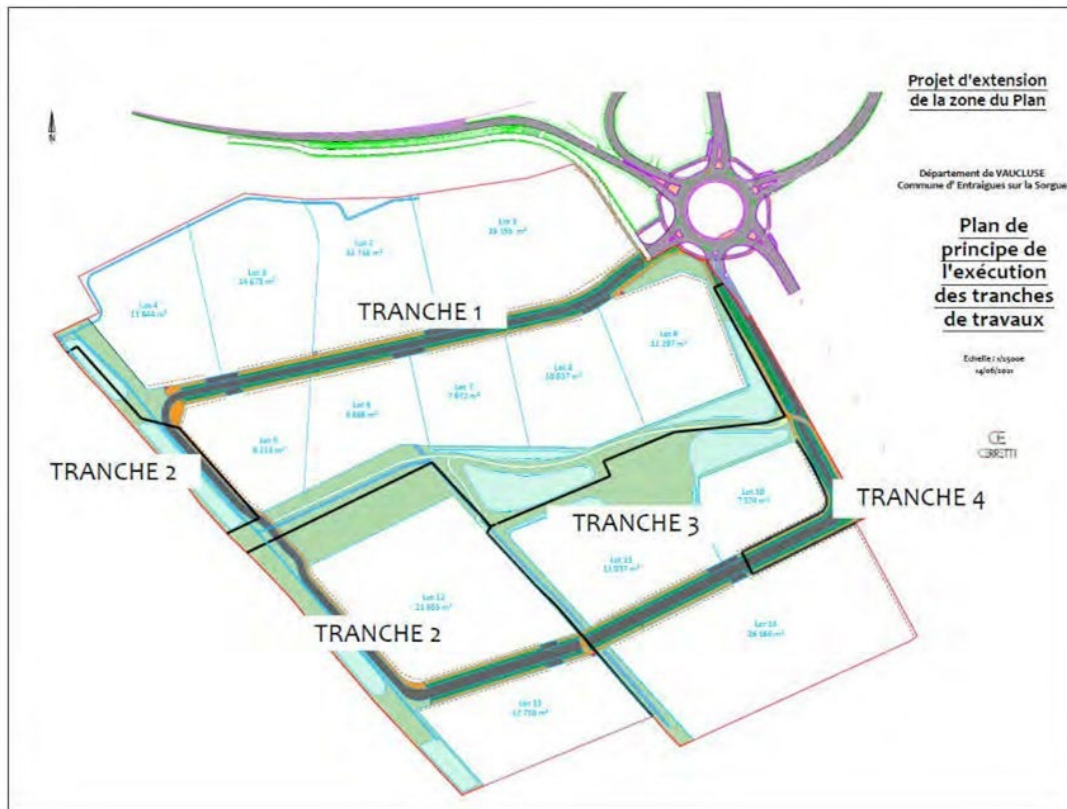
PHASAGE DES TRAVAUX PREVUS SUR 4 TRANCHES DE LA ZAC DU PLAN (SOURCE : GRAND AVIGNON / CERRETTI)
